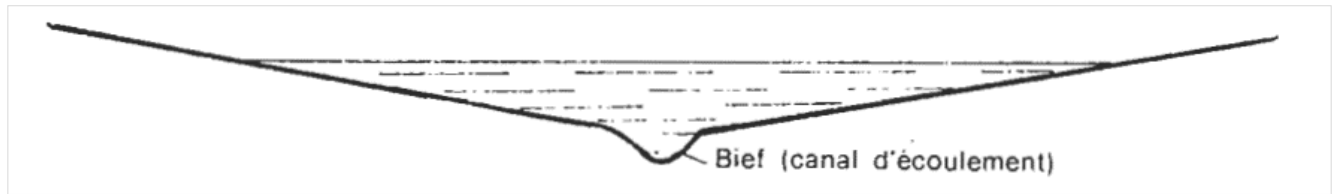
Coupe transversale d'un étang, avec le profil typique des berges en pente douce⁵⁶
